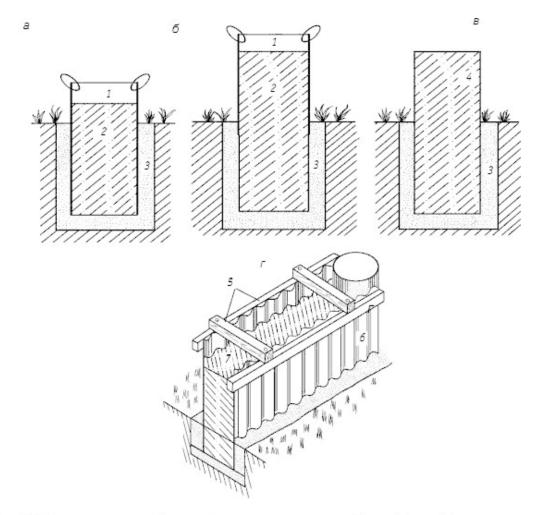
Изготовление столбчатого фундамента в скользящей опалубке-трубе: а — нижняя часть столба; б — верхняя часть столба; в — готовый фундаментный столб; г — стена-перегородка между фундаментными столбами: 1 — опалубка-труба; 2 — бетон; 3 — песчаная засыпка; 4 — готовый столб; 5 — деревянная рама; 6 — шифер; 7 — минеральная засыпка
